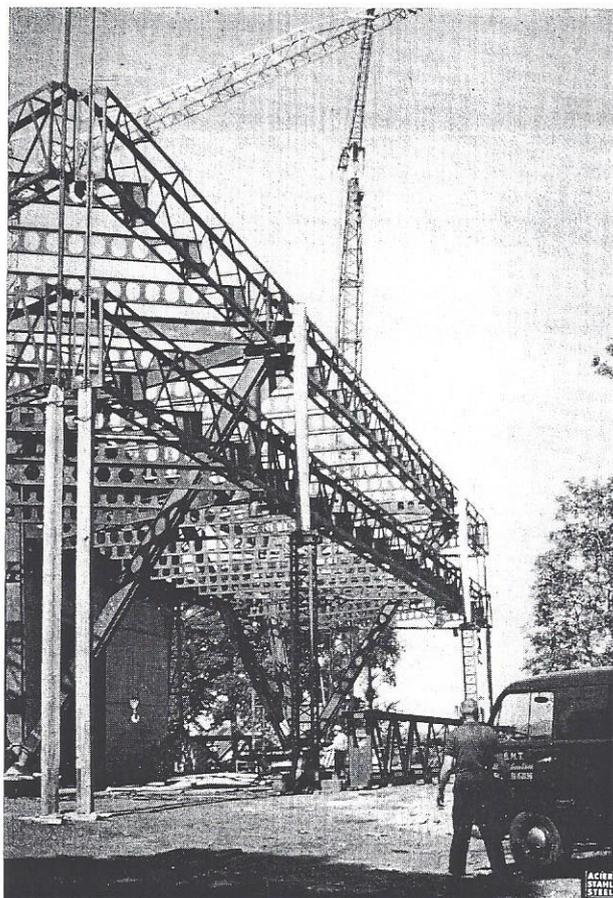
Vue de l'ossature montrant les poutres en treillis et les poutres Litzka.
